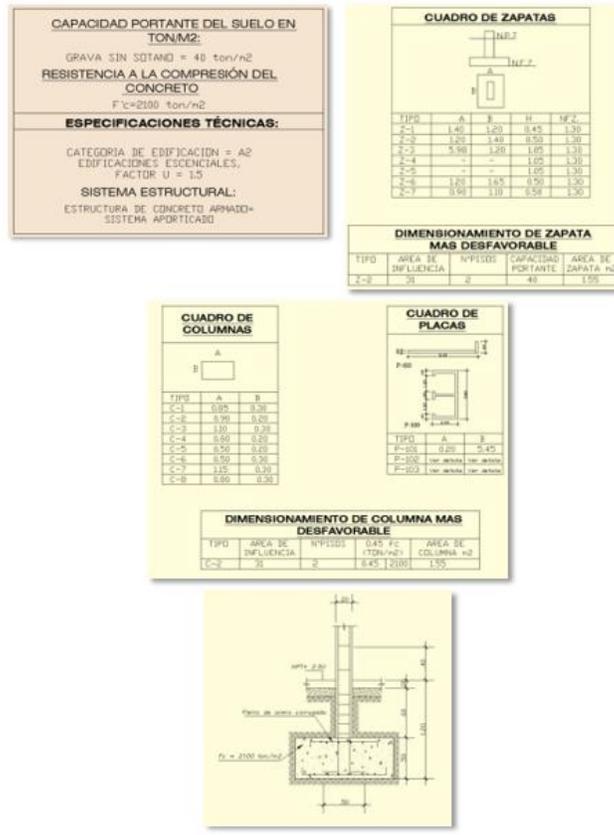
Detalle de zapata Z/2 Corte. Fuente Elaboración propia
